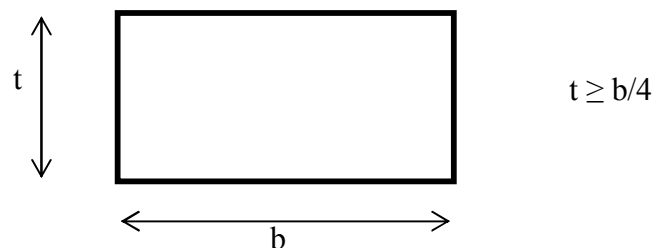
condition des dimensions d'un poteau en maçonnerie
